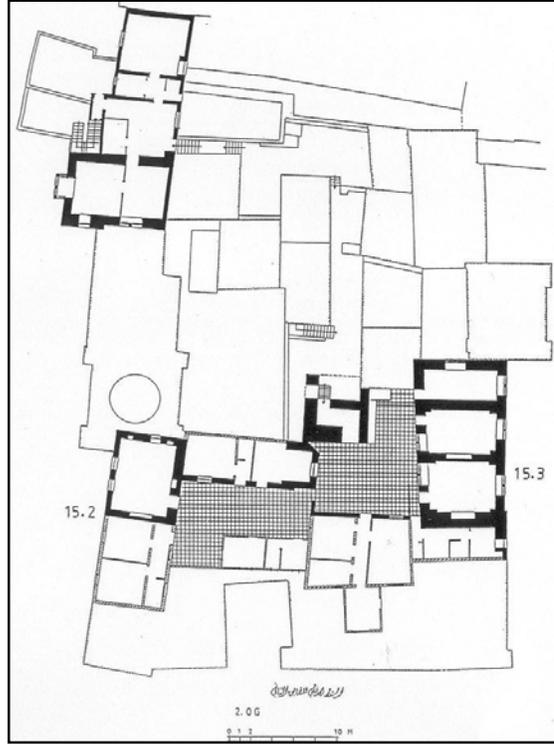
المسقط الأفقي للطابق الأرضي في قصر النمر
